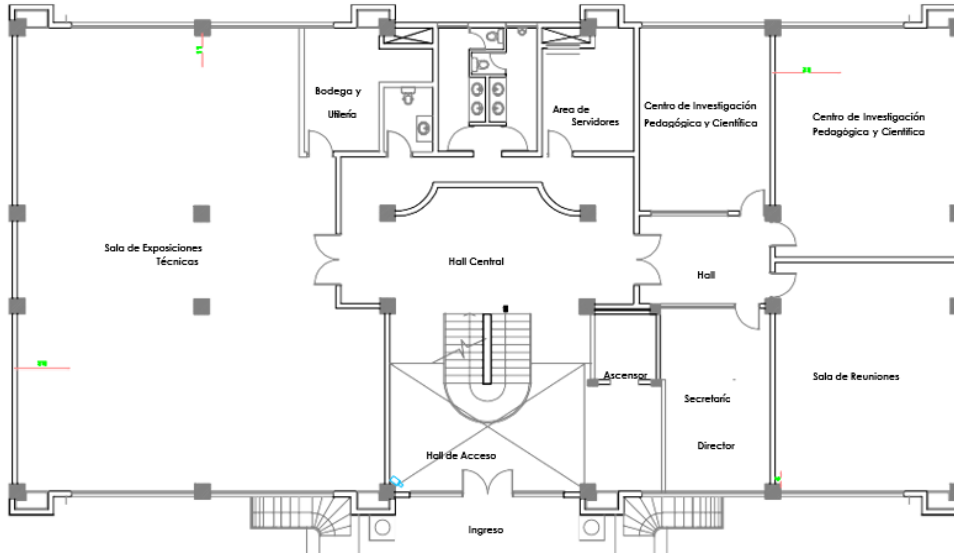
Planos de Infraestructura Planta Baja Laboratorios
